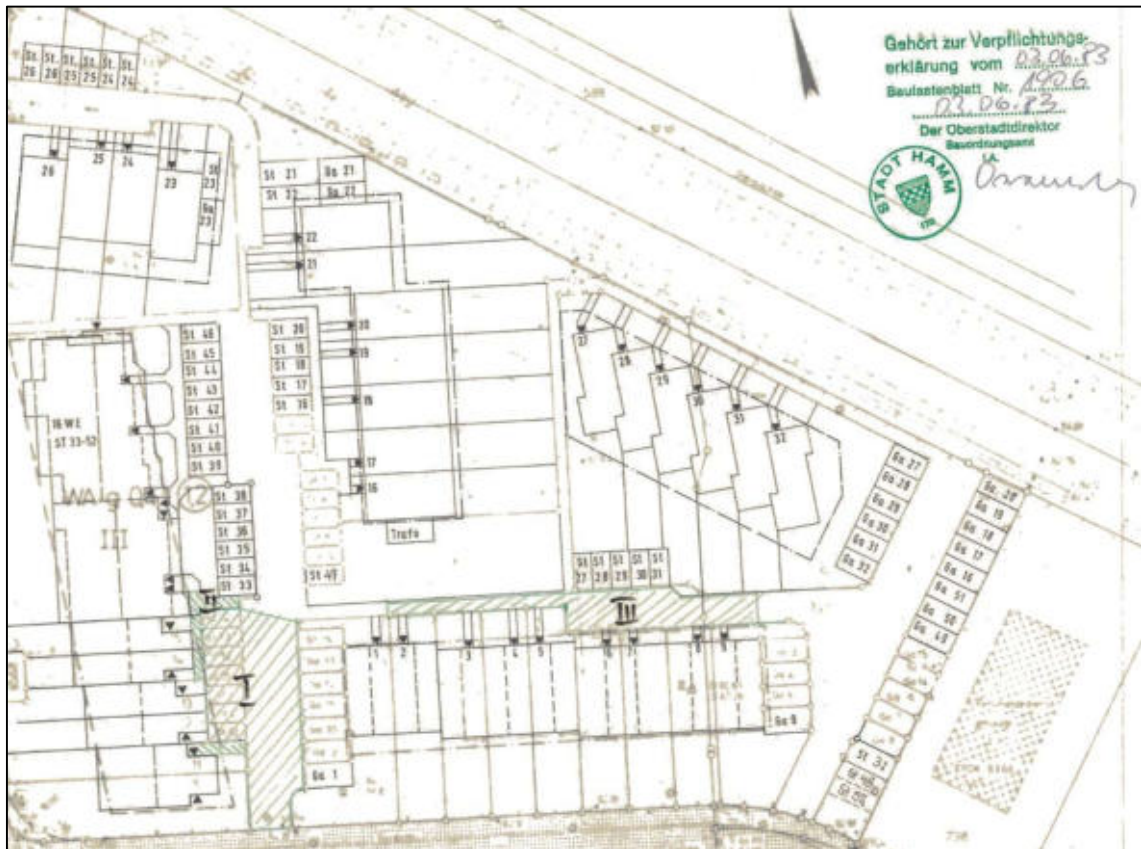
Lageplan zu den Baulasten lfd. Nrn. 2, 3 und 7
